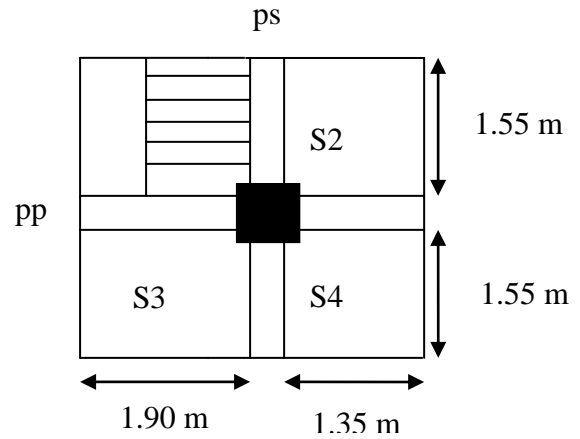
Surface afférente du poteau 2 (présence de l'escalier)
